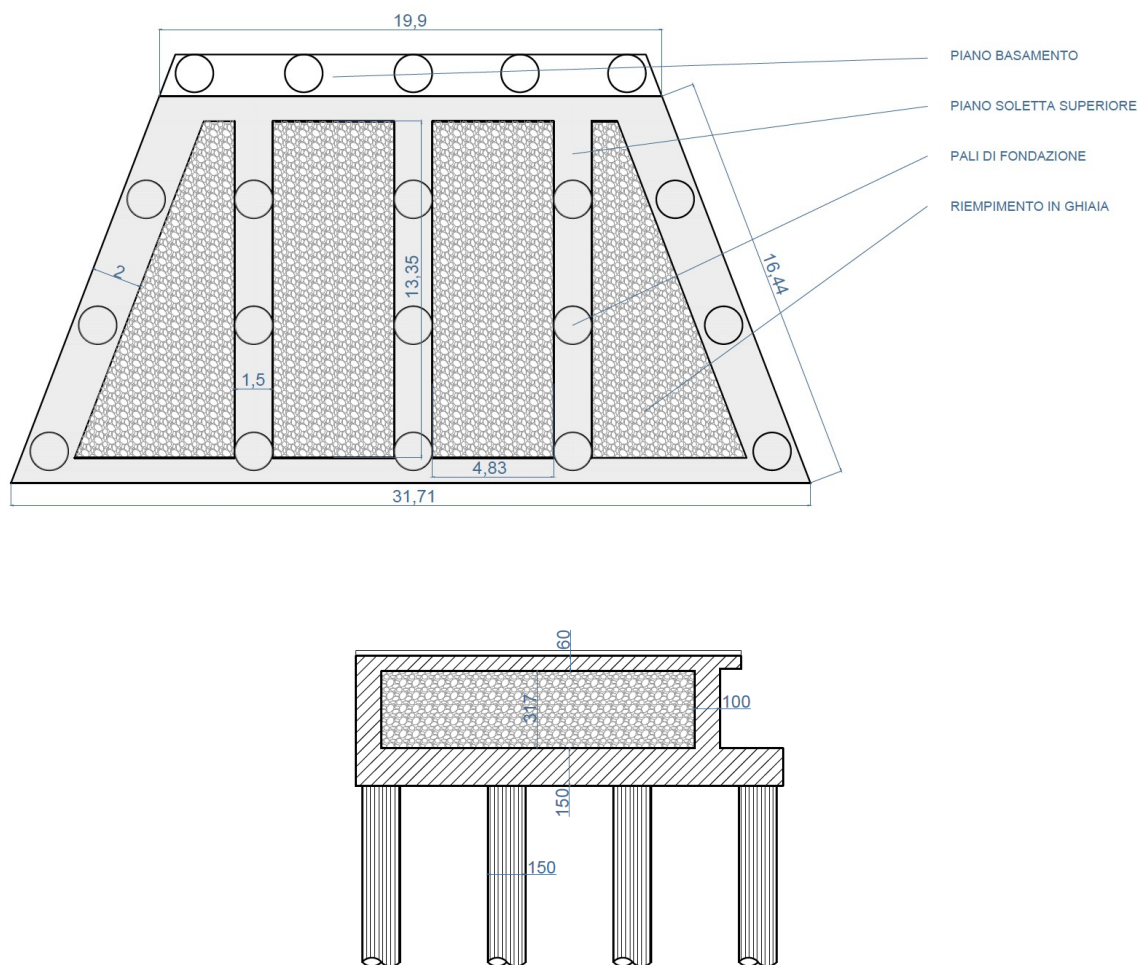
sezioni di spalla zavorrata in sinistra idraulica
